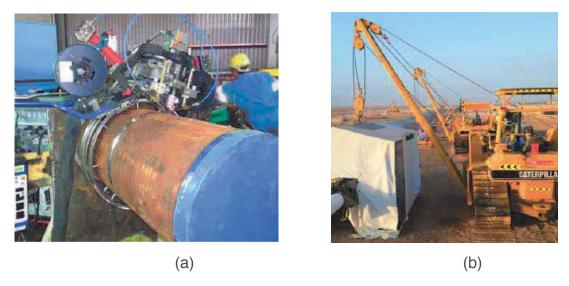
(a) Soldagem GTAW- MMCAQ orbital. (b) Tenda ("shelter").
